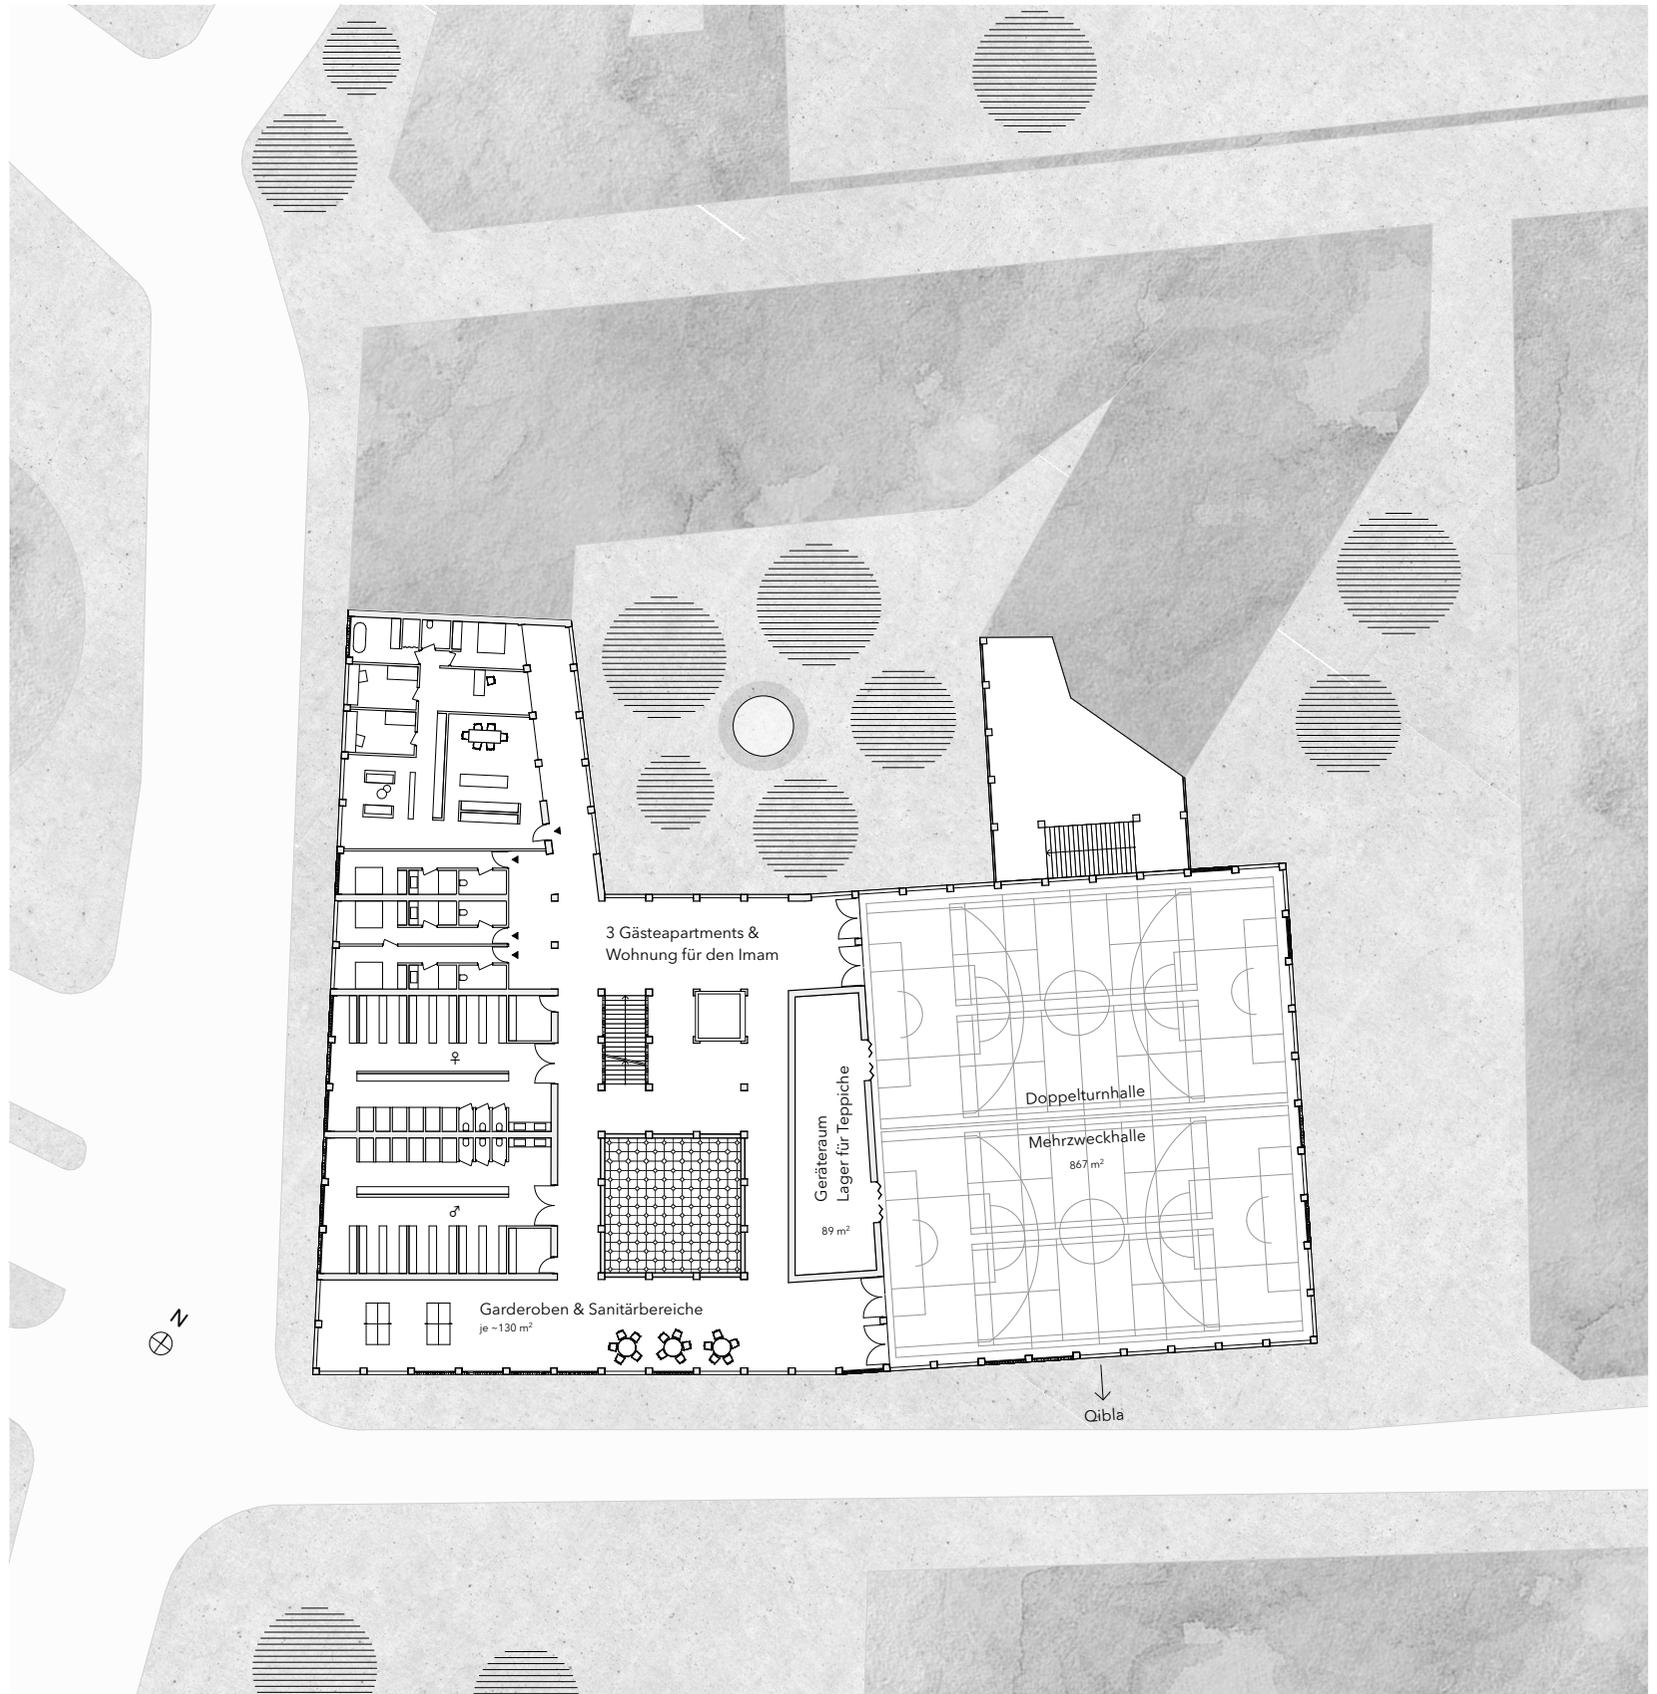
Grundriss Ebene 2 | 1:500
